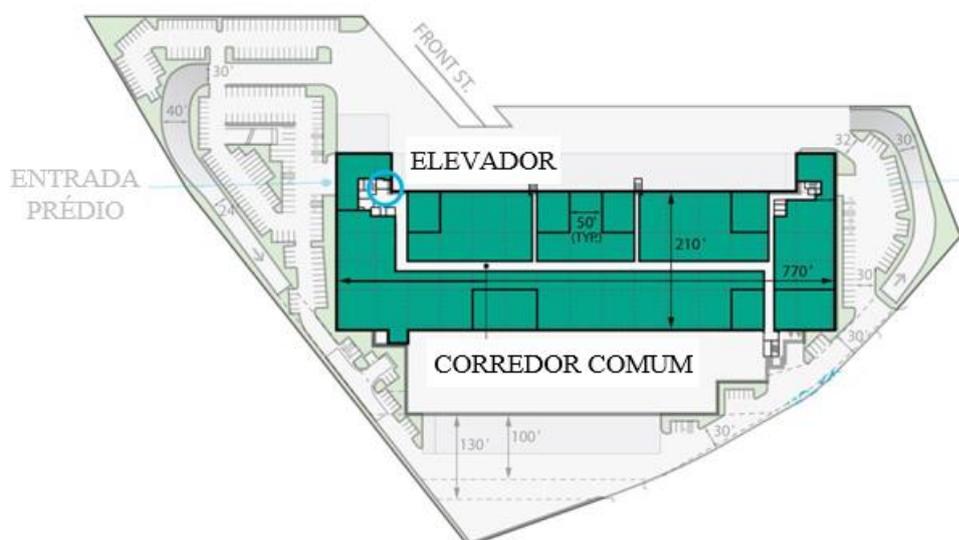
Planta do projeto Georgetown Crossroads (segundo andar)
